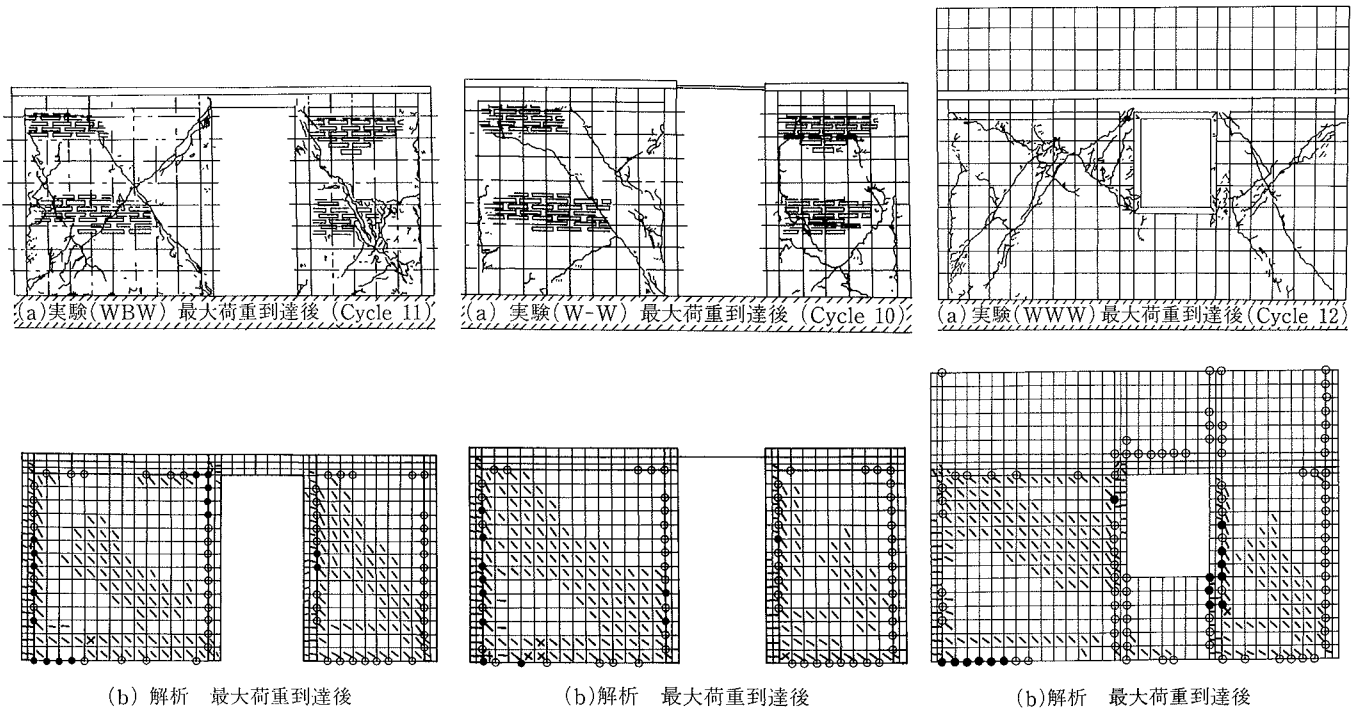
WBW 試験体のひび割れ状況 図-15 W-W 試験体のひび割れ状況 図-16 WWW 試験体のひび割れ状況
